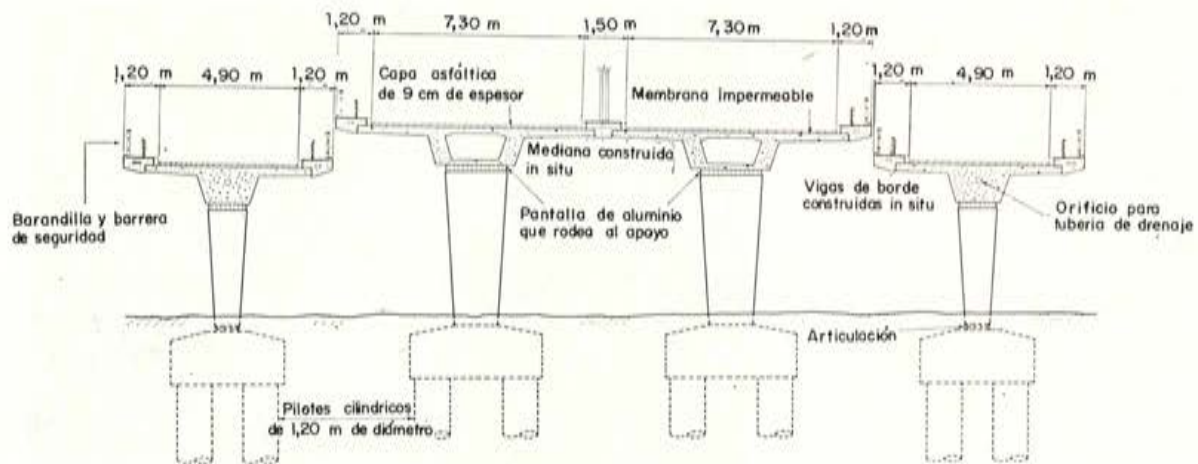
Paso elevado de Mancunian Way, en Manchester. Sección transversal de la estructura con doble calzada de dos carriles y rampas de acceso.
